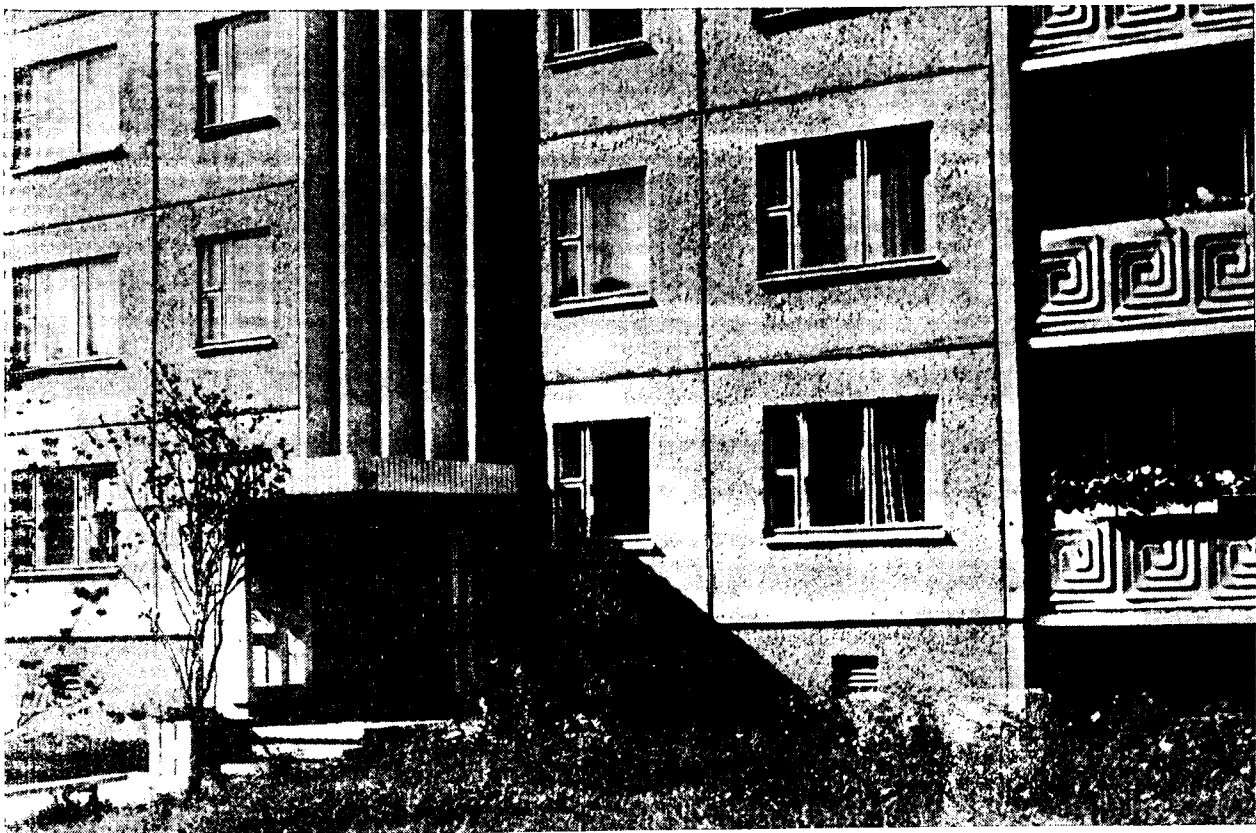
Вход в жилой дом, примыкающий к лоджиям и к панельной стене (Минск)
